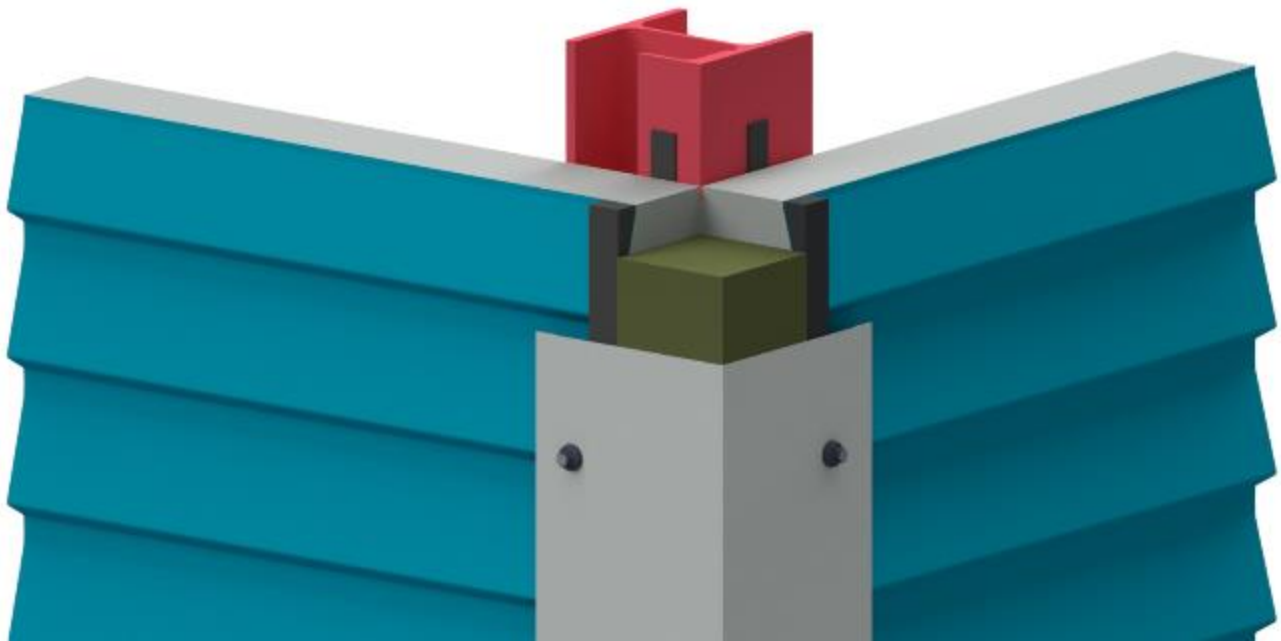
Exemple d'angle sortant assemblé sur site en pose verticale avec panneau sandwich isolant Louvre
